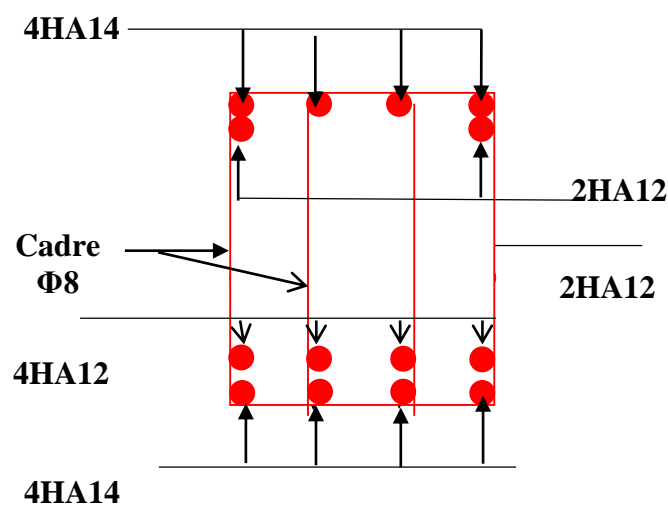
Schéma de ferrailage de la poutre brisée.
